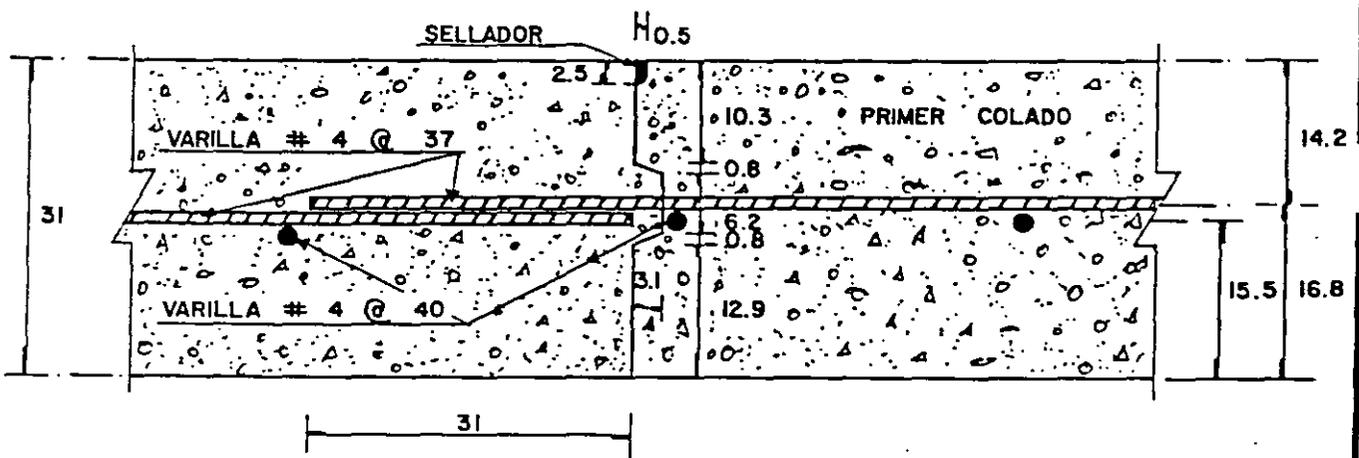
Características del armado longitudinal para los dos tipos de pavimento rígido.
